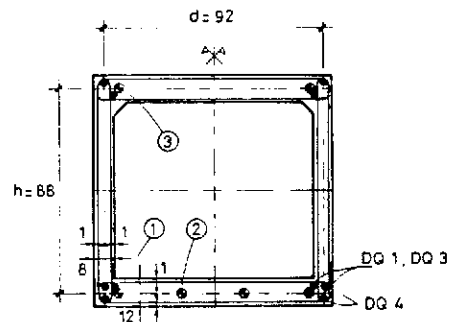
Geometría de la sección transversal y disposición de las armaduras, en los ensayos DQ1, DQ3 y DQ4.
